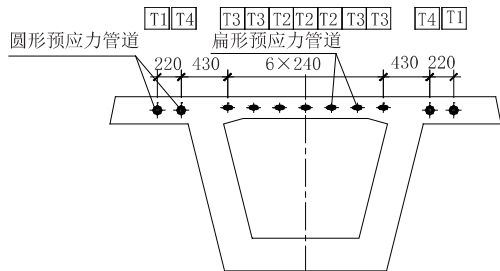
小箱梁墩顶负弯矩断面示意图(单位:mm)
